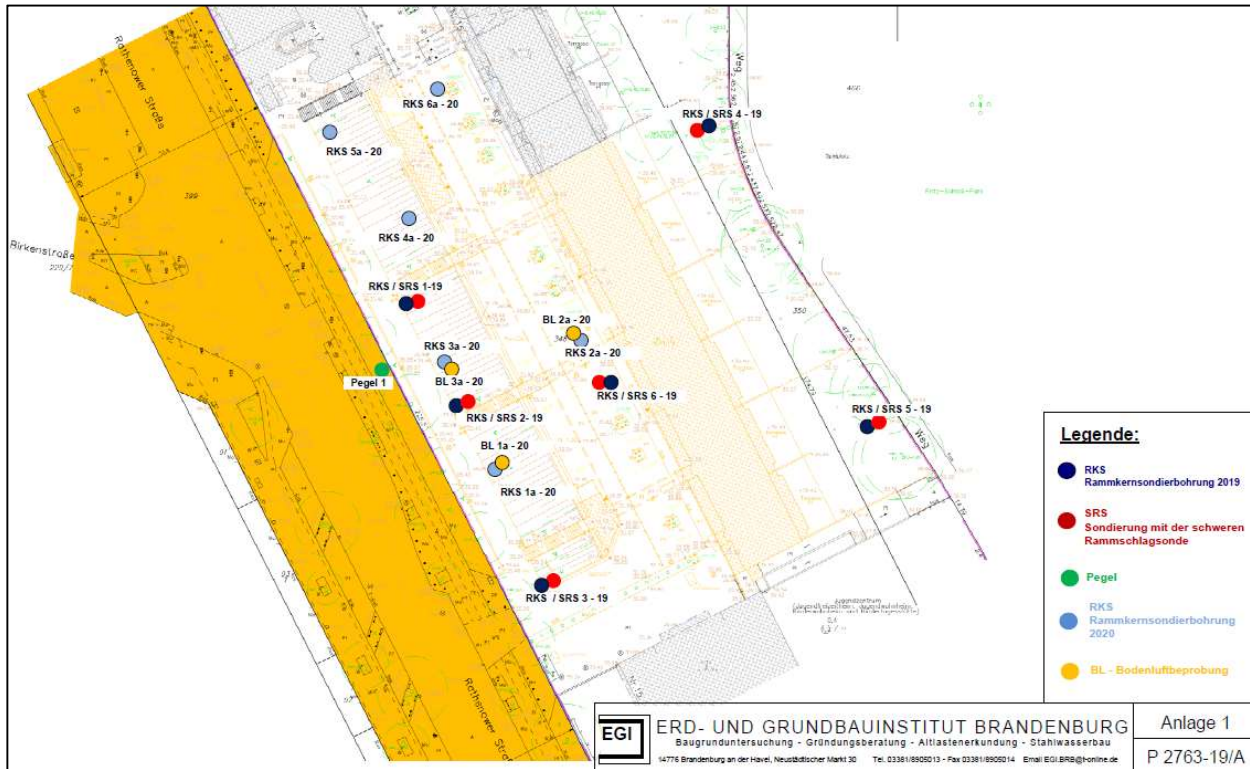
Lageplan mit eingetragenen Bohr- und Sondierpunkten (vgl. Anlage 1, Altlastengutachten von 2020).
